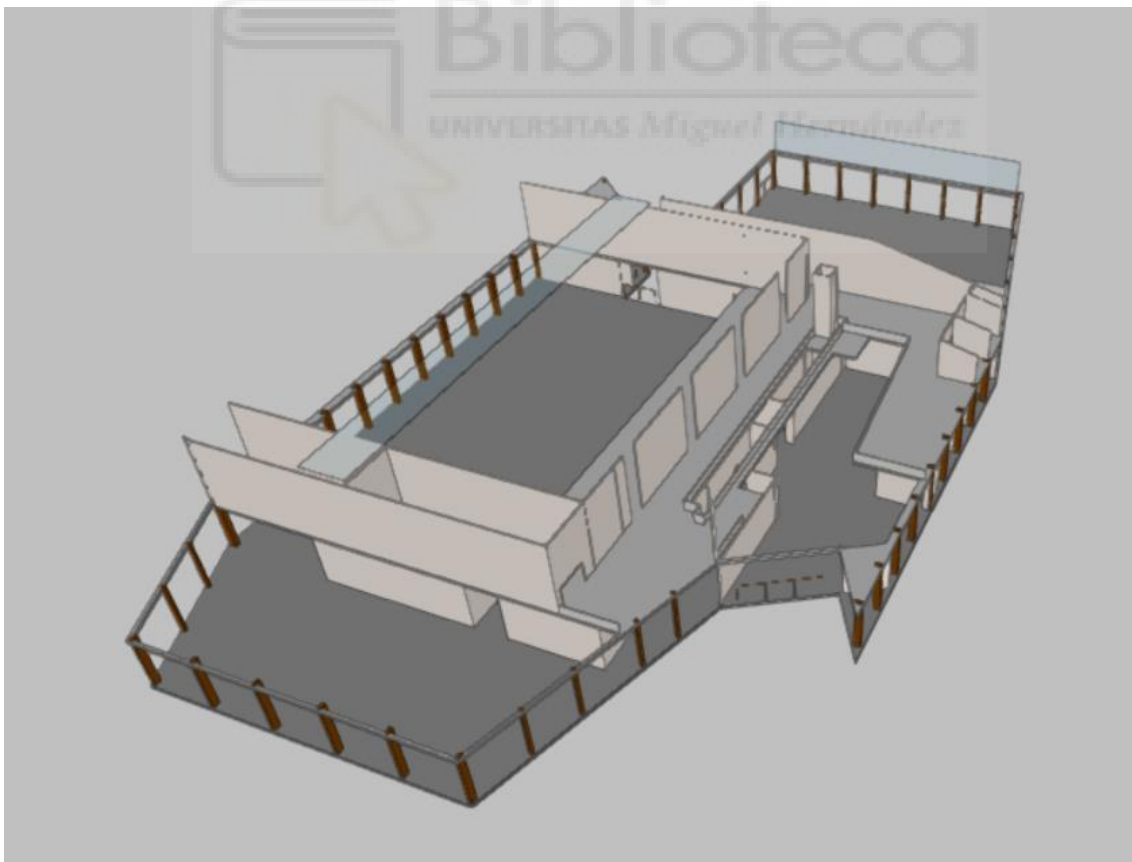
Vista 3D, interior del edificio, sin cubierta, sin fachada y con lucernario
